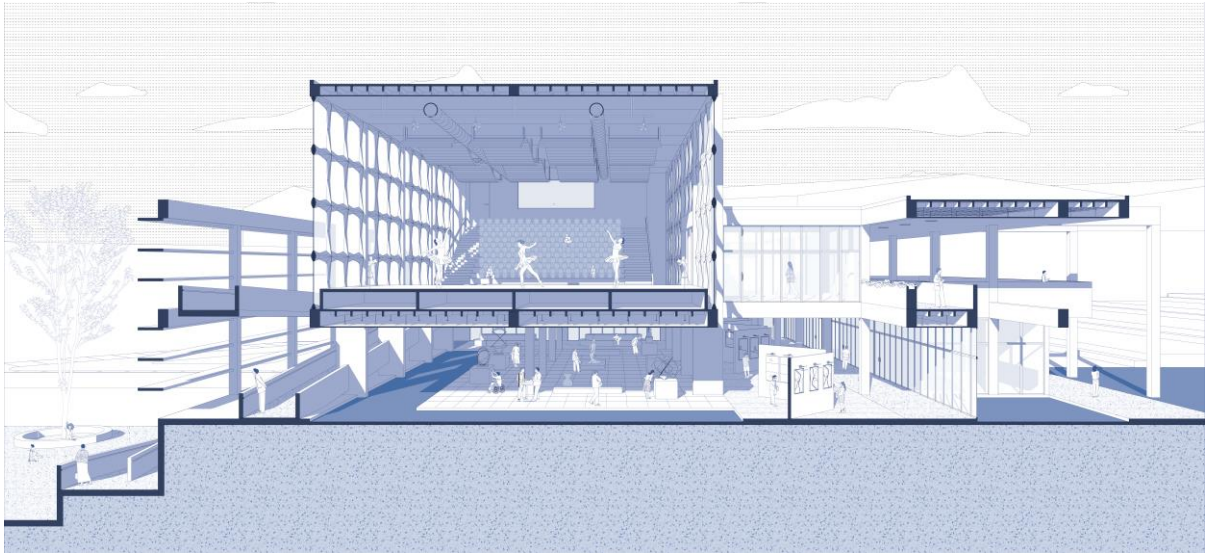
Fachada Longitudinal. Elaboración propia.
